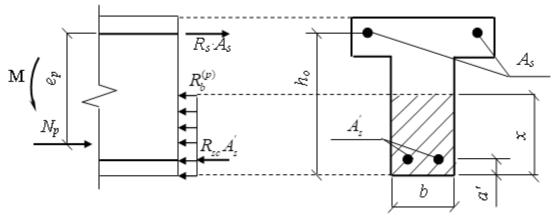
Схема усилий в поперечном сечении железобетонного элемента с прямоугольной сжатой зоной в стадии предварительного обжатия
